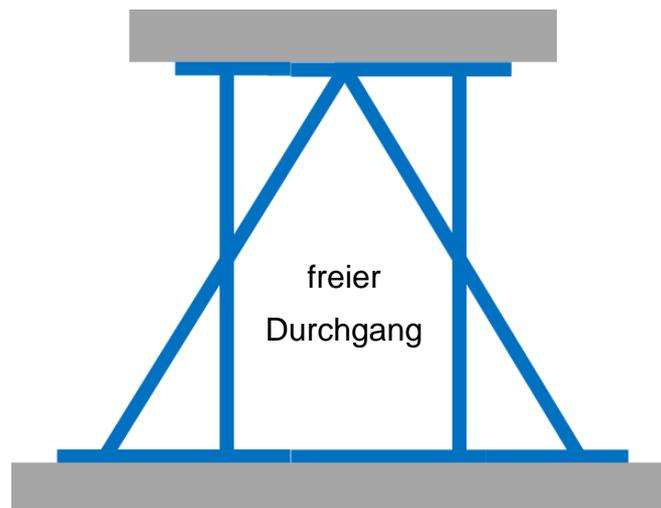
Aussteifung eines Flächenfachwerks mit einer A-Verstrebung
